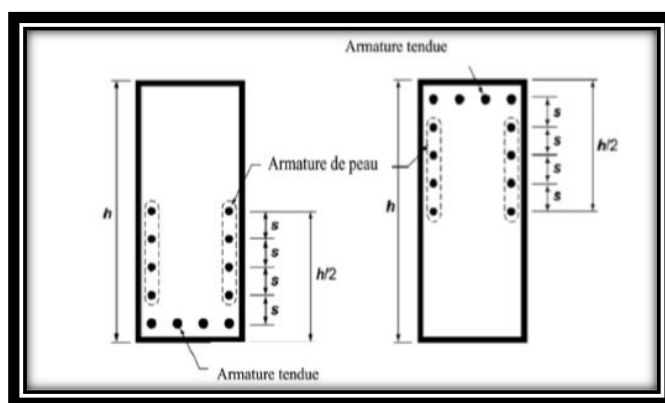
Disposition des armatures de peau pour les poutres de hauteur $h > 900$ mm.
